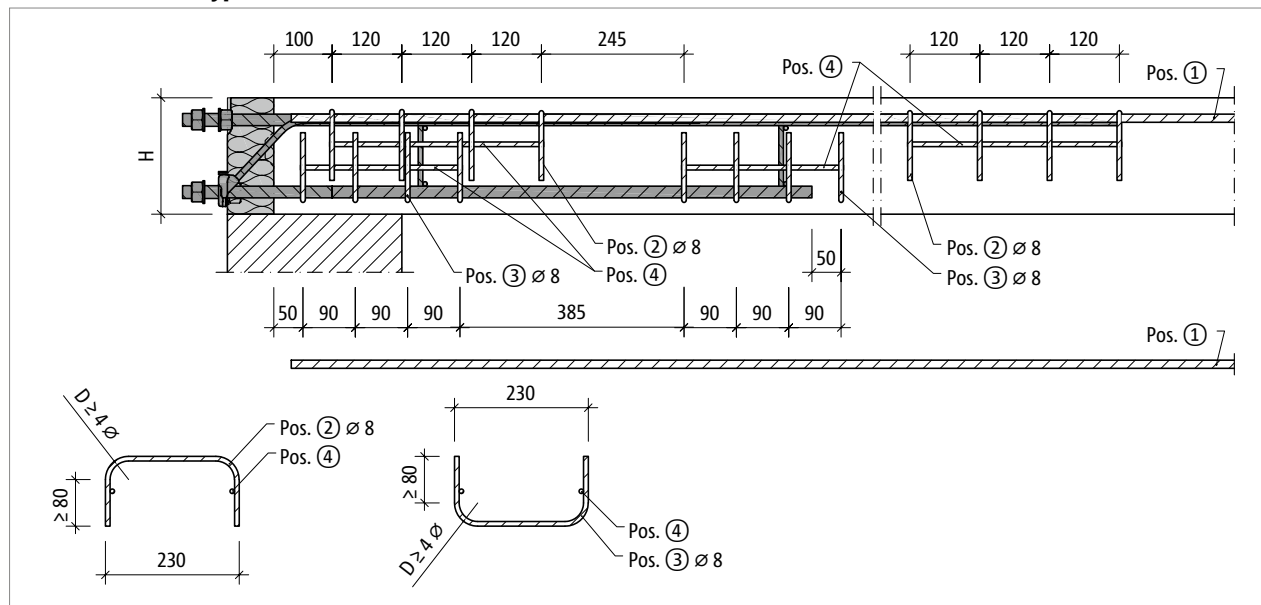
Schöck Isokorb® T Typ SKP-MM2: Bauseitige Bewehrung mit Bügel Ø 8 mm; Schnitt
